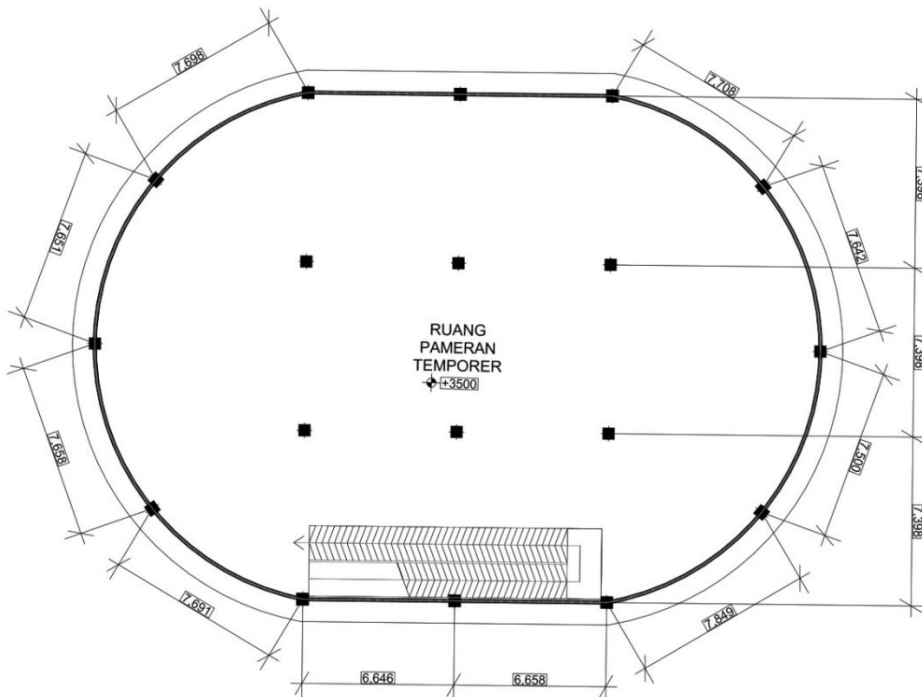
Denah Skematik Lantai 3 Gubahan 1
